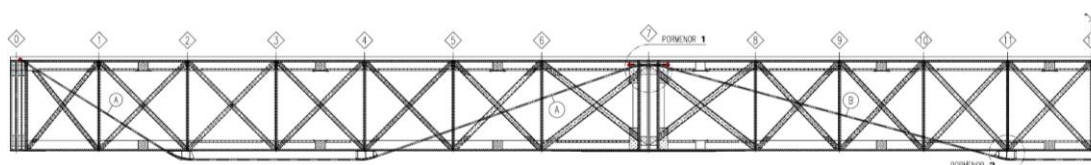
Exemplo da aplicação de pré-esforço exterior (adaptado de [37])
